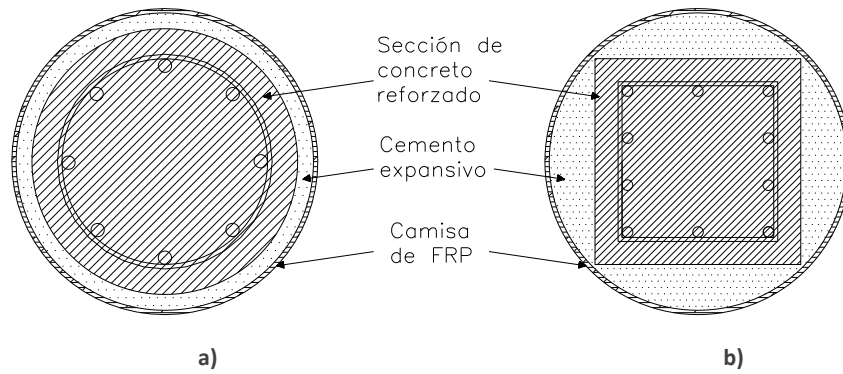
Confinamiento con FRP activo: a) columna circular y; b) columna cuadrada.
